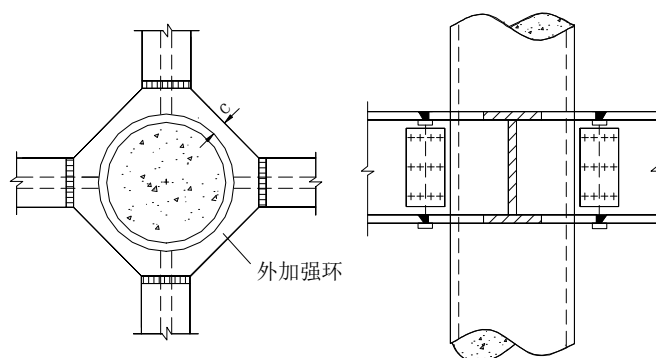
钢梁与钢管混凝土柱采用外加强环连接构造示意
